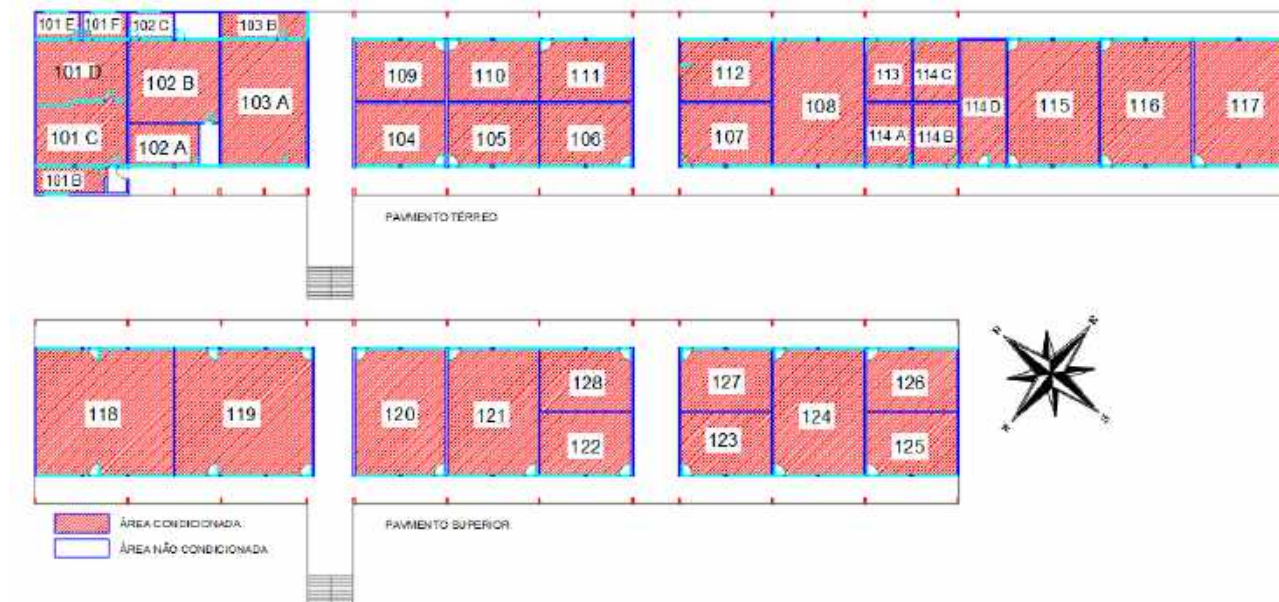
Planta Baixa da edificação em estudo – Pavimento térreo e superior
